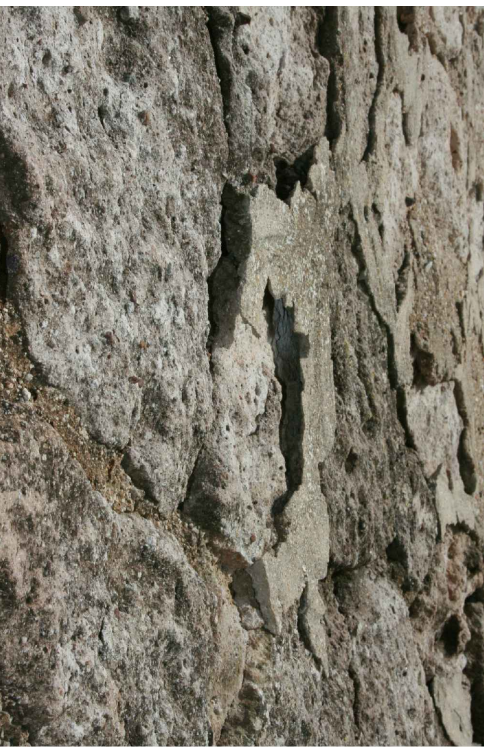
Alveolizzazione e distacco delle malte a raso pietra.
